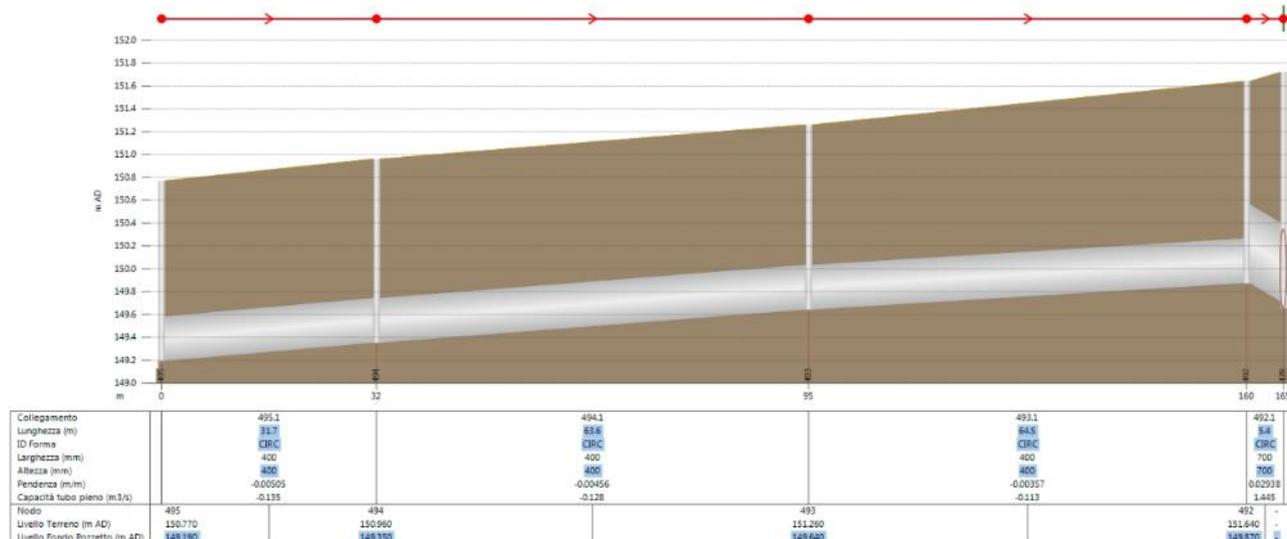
Profilo tubazione esistente via Magellano, dalla camera 495 alla camera 478
